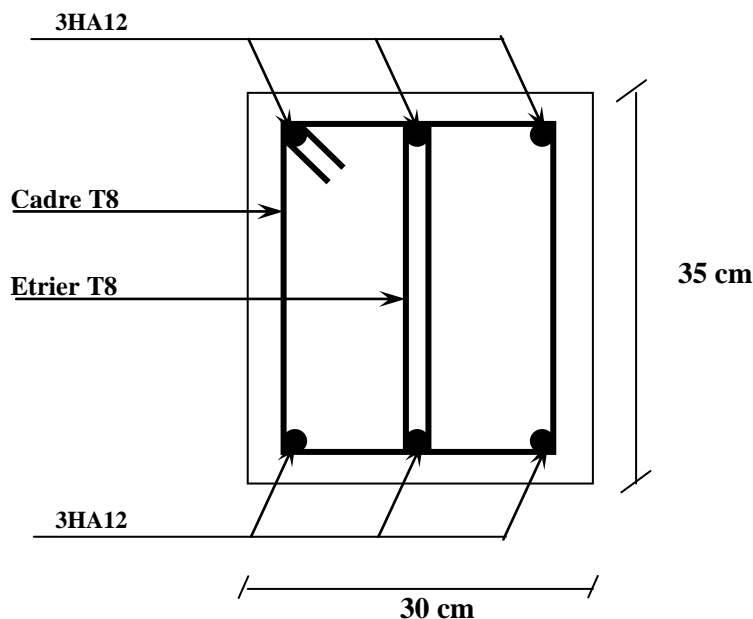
Schéma de ferrailage de la poutre de chaînage
